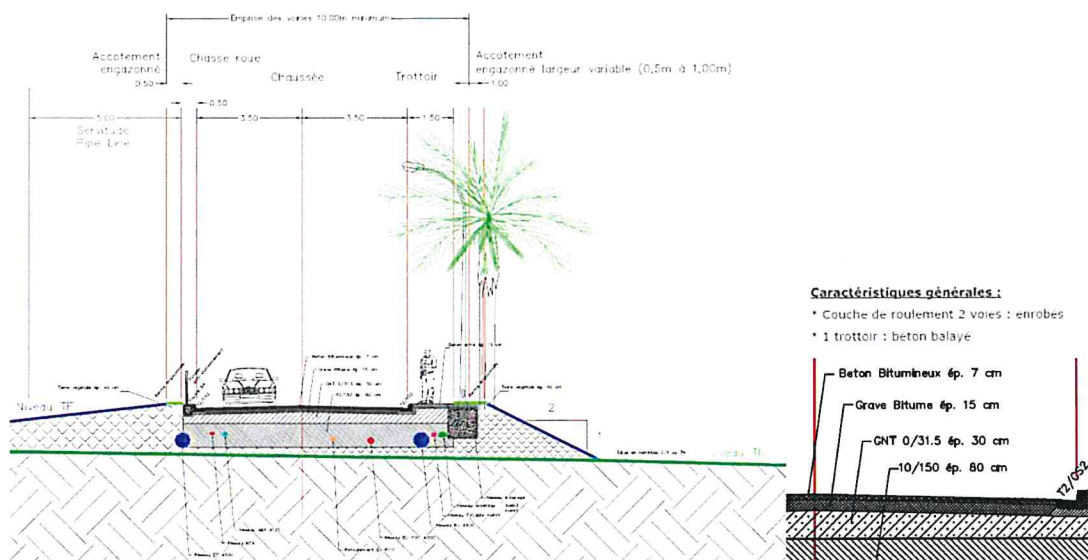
profil en travers type de la voie de liaison (source : Suez Consulting)
